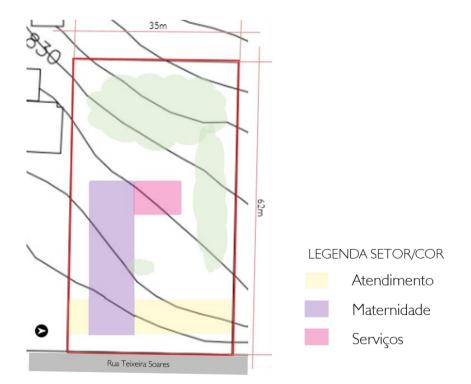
Estudo de implantação 2 - planta baixa esquemática
